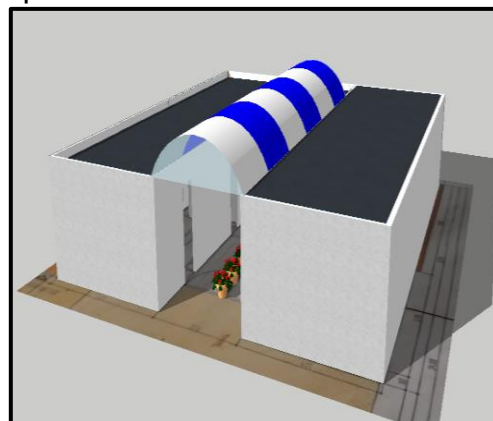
Esquema Refuerzo Mampostería.
